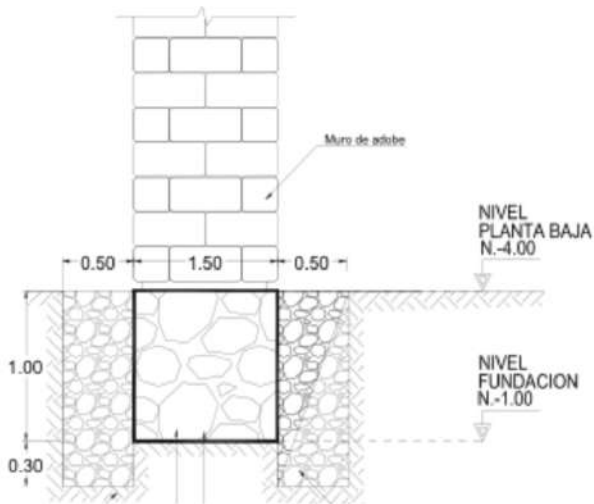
Calzadura en cimentación tipo- planta baja nivel N.+0.00
